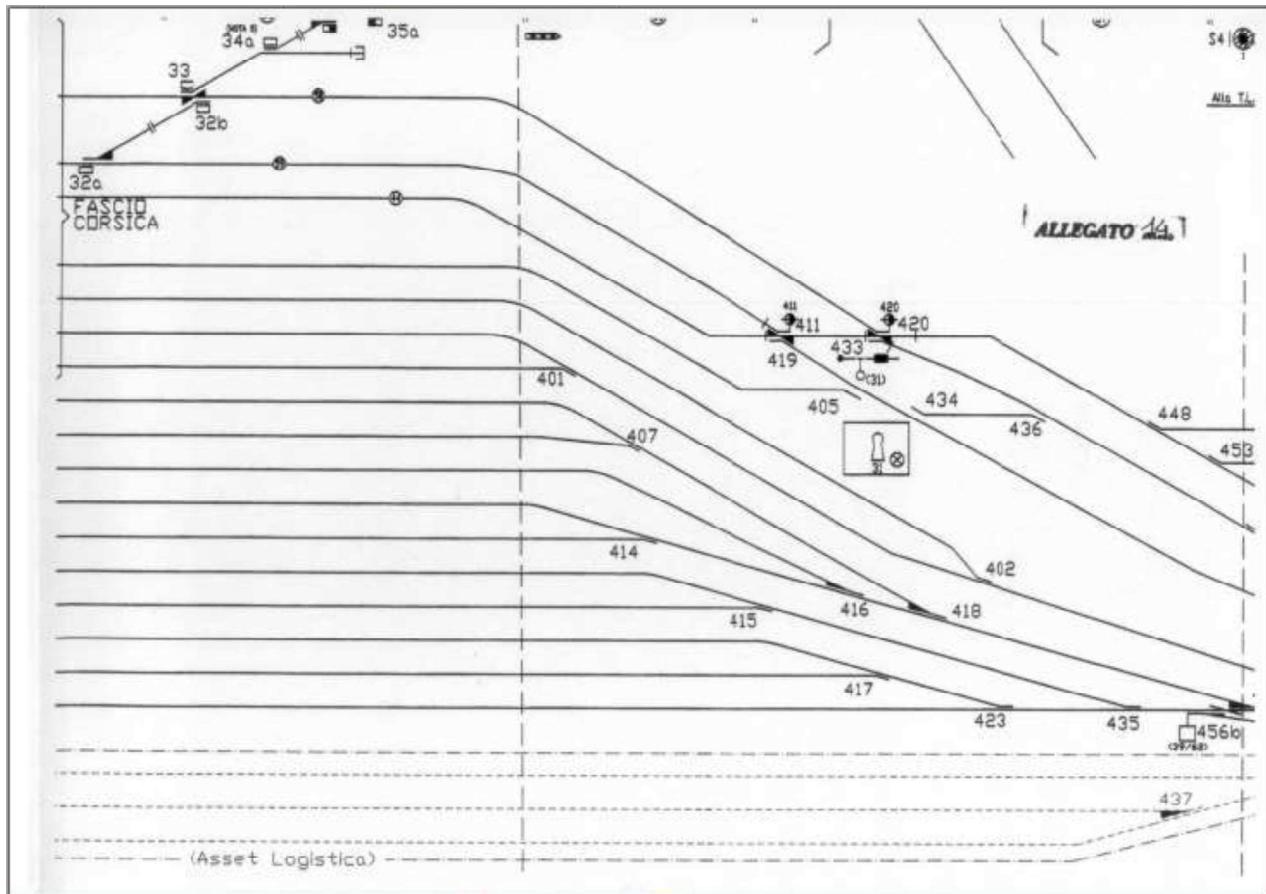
Stralcio del piano schematico dell'impianto di Novara Boschetto
